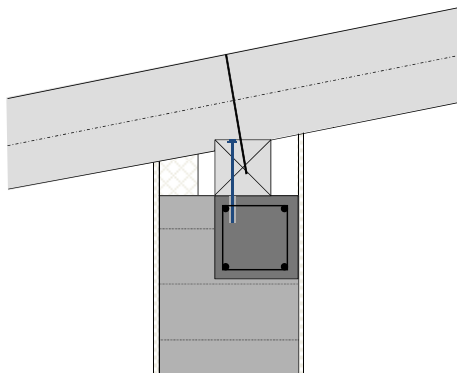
Cordolo quale collegamento fra la travatura del tetto e la parete
